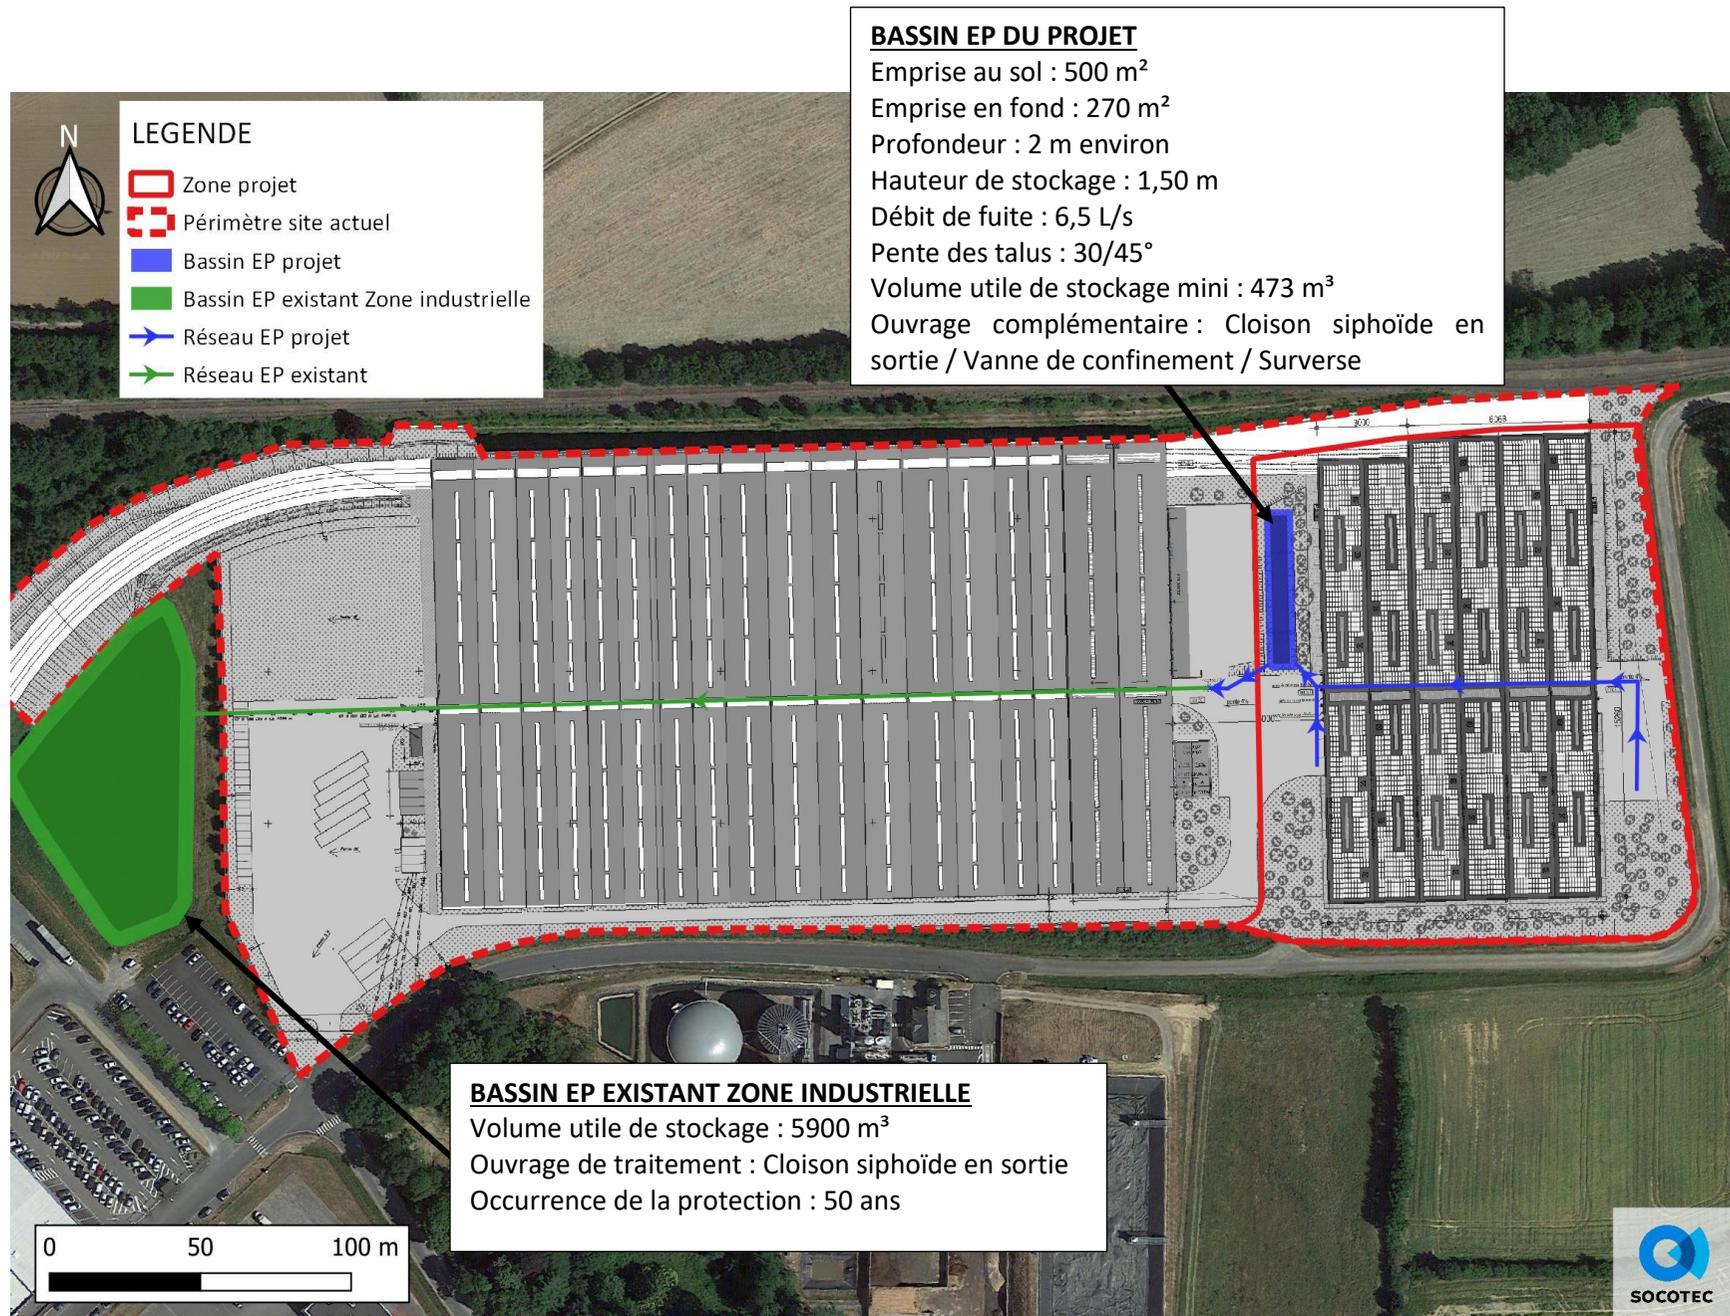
Schéma de principe d'assainissement des eaux pluviales
